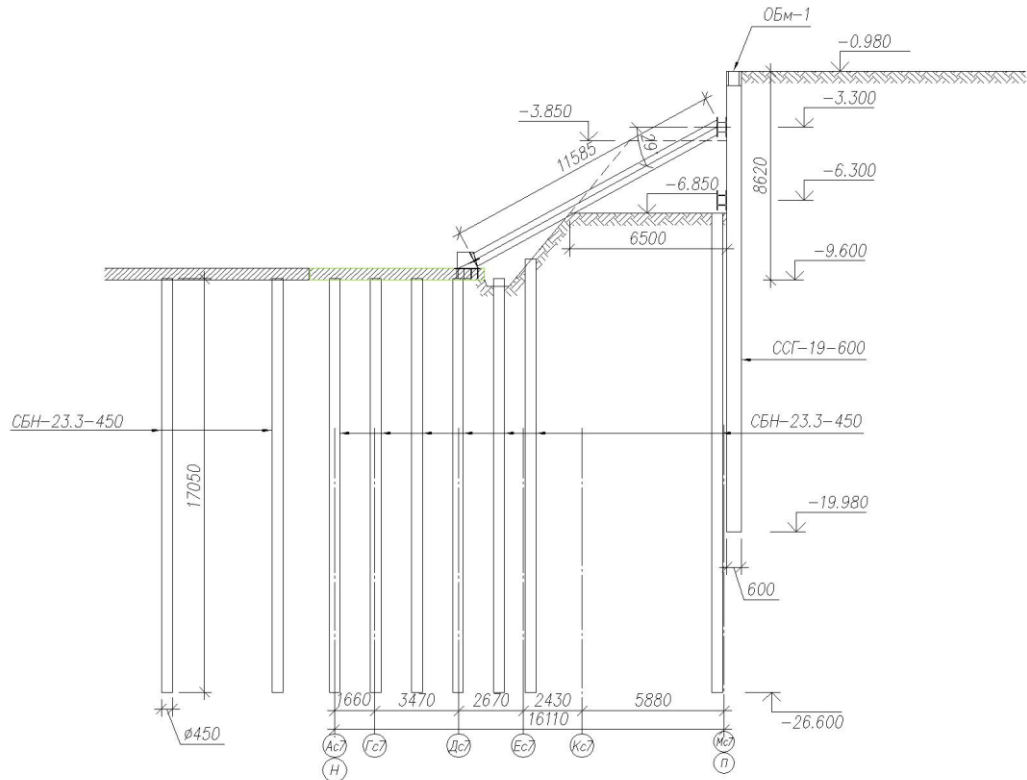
Второй этап, локальная экскавация грунтовой бермы, монтаж подкосов верхнего яруса.
